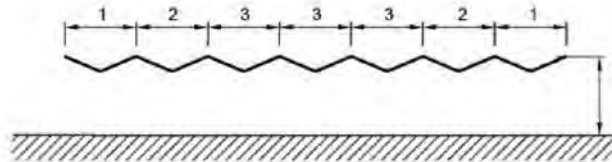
Tettoie a falda multipla: individuazione dei vari elementi
